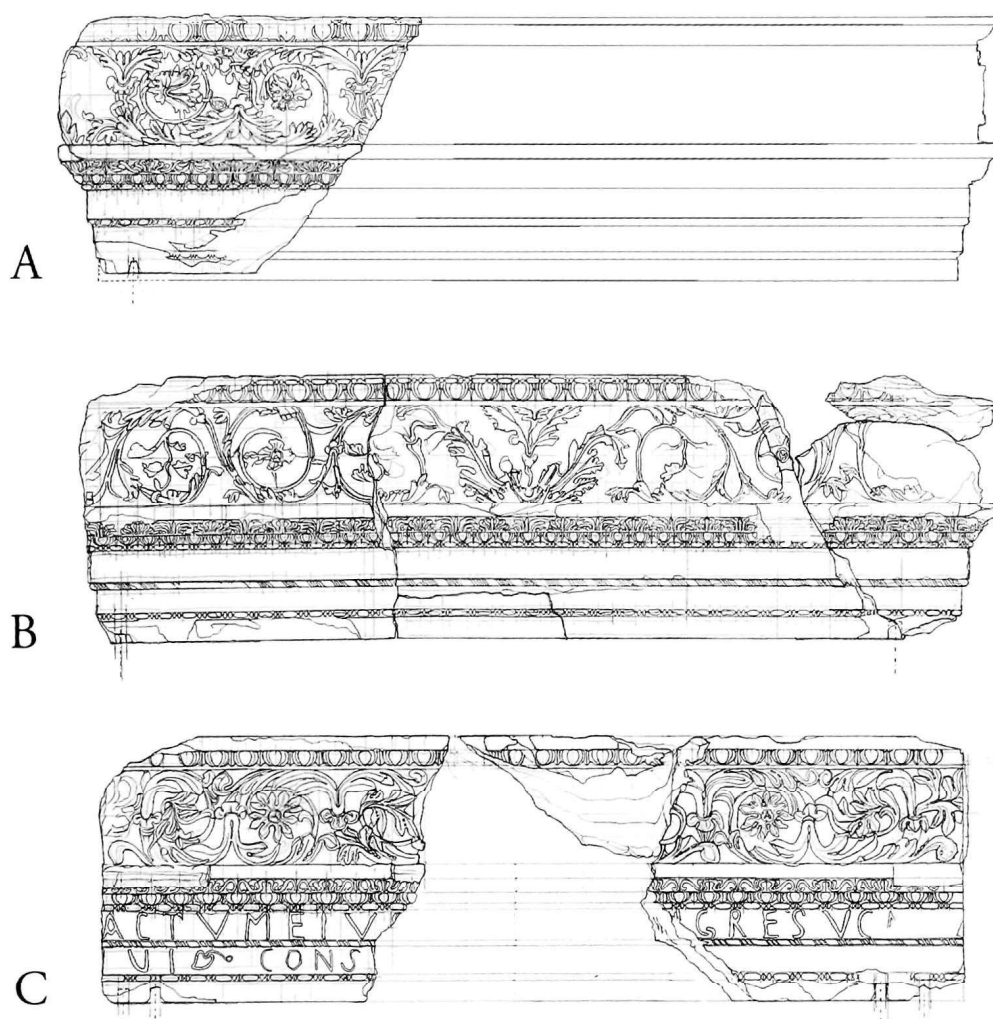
a,b) Frammenti delle lastre marmoree di rivestimento della trabeazione settentrionale appartenenti ad un edificio di età antonina; c) Lastra di rivestimento del tratto mediano della trabeazione pertinente al restauro del prospetto settentrionale del tempio (ril. M.A. Mellace).
